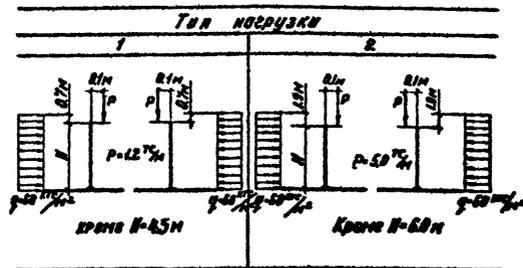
Схемы расчетных нагрузок на перегородки высотой 3,6 + 6,0 м.
